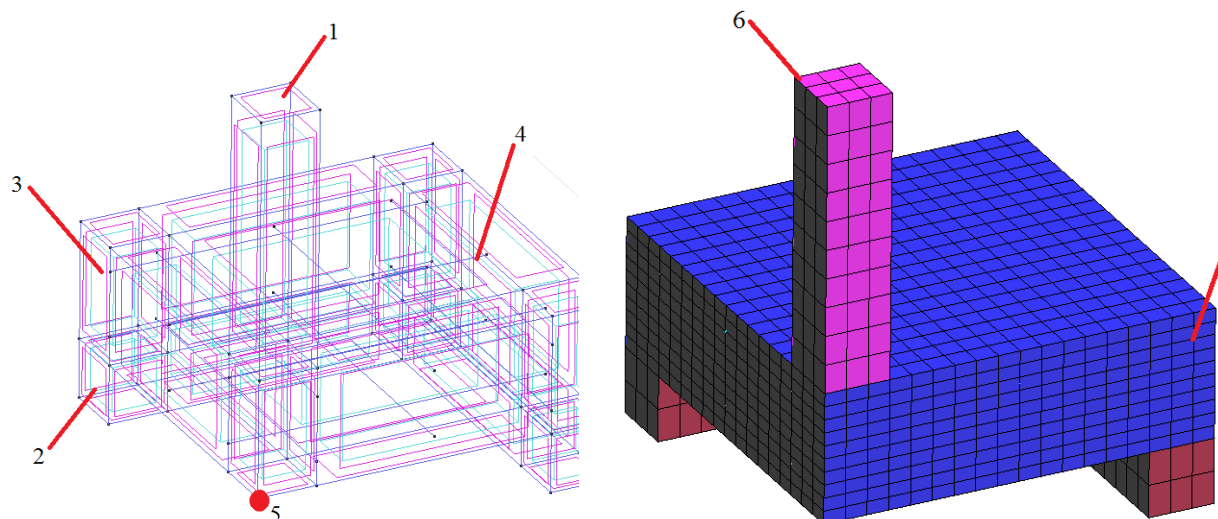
3D (слева) и КЭ (справа) модели для численных исследований с использованием ПК АТЕНА: 1 – колонна; 2 – опорная конструкция; 3 – плита перекрытия; 4 – арматурные стержни; 5 – точка мониторинга перемещений вдоль вертикальной оси; 6 – место приложения нагрузки; 7 – закрепление образца от смещения из плоскости симметрии [74]
